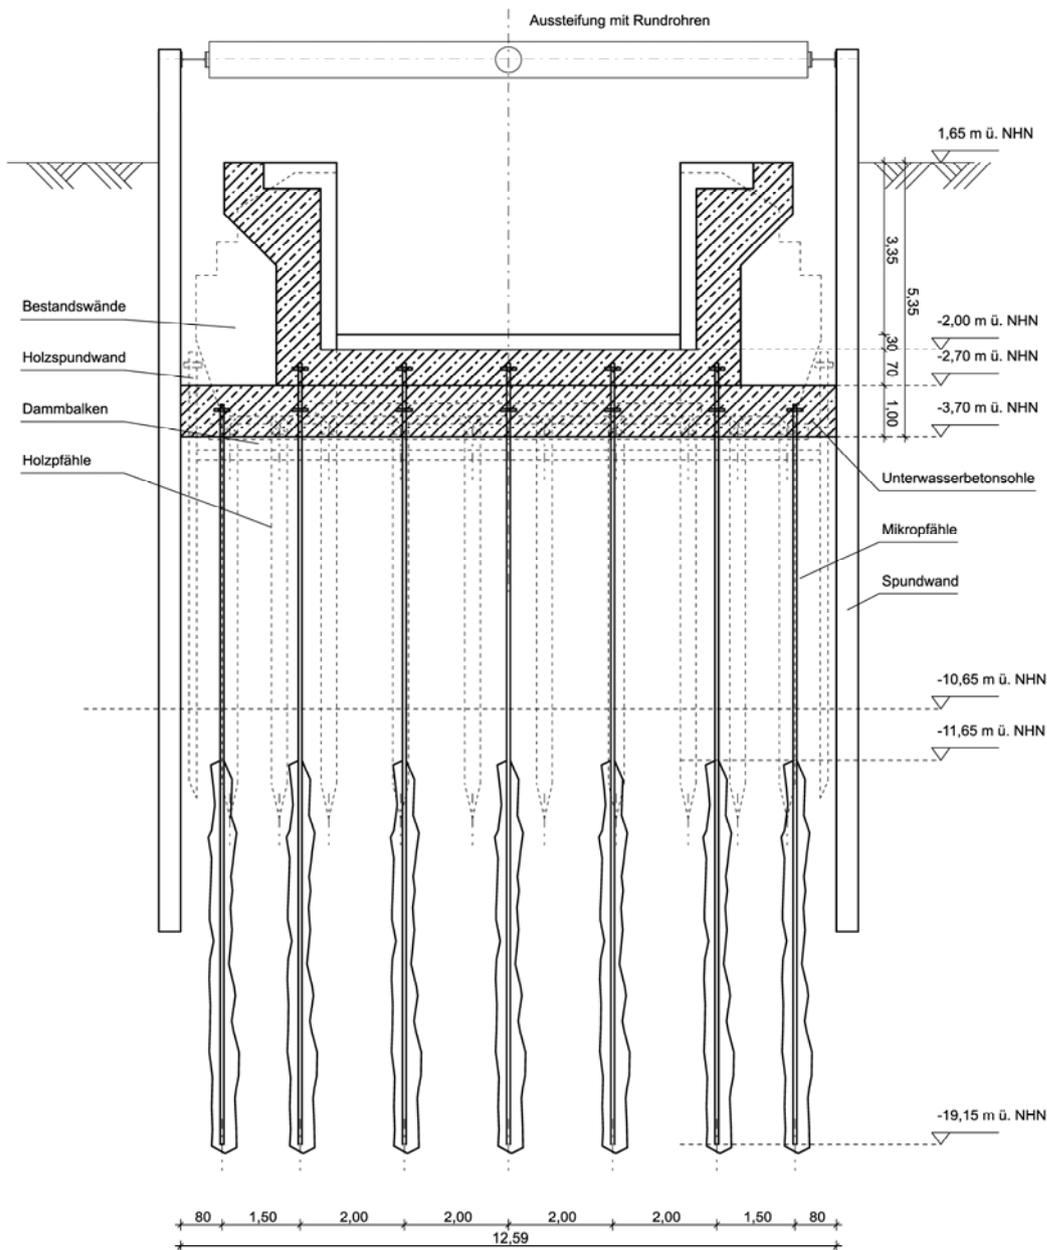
Konzept Baugrubensicherung - Schnitt Schleusenammer Variante 1 (Bestandssanierung mit Stahlbetontrog)
